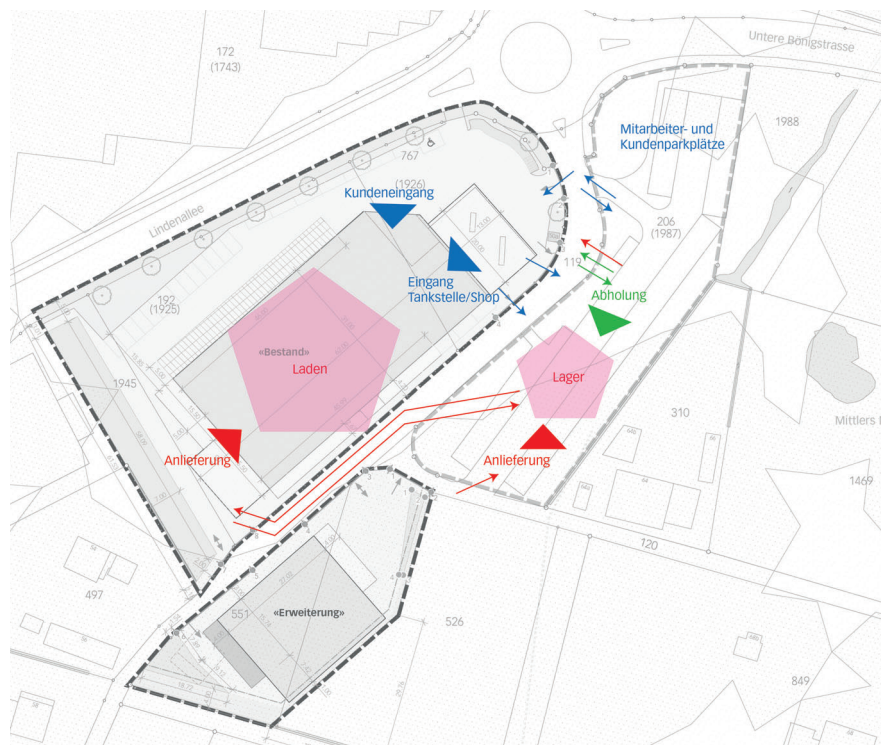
Erschliessungsschema mit Lagergebäude im südlichen Teil der ZPP
